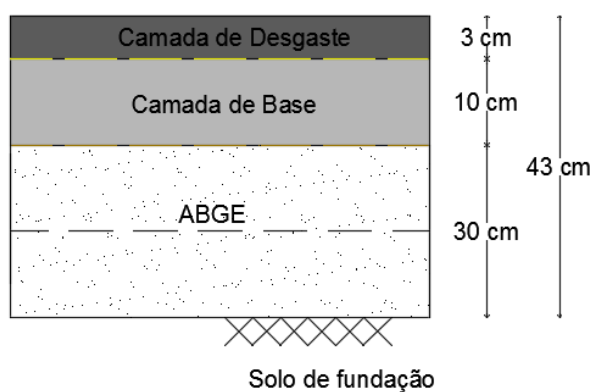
Estrutura do pavimento existente na Avenida da Republica.
